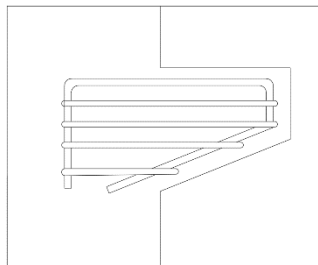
1 Detail sambungan pada Balok dengan Kolom
